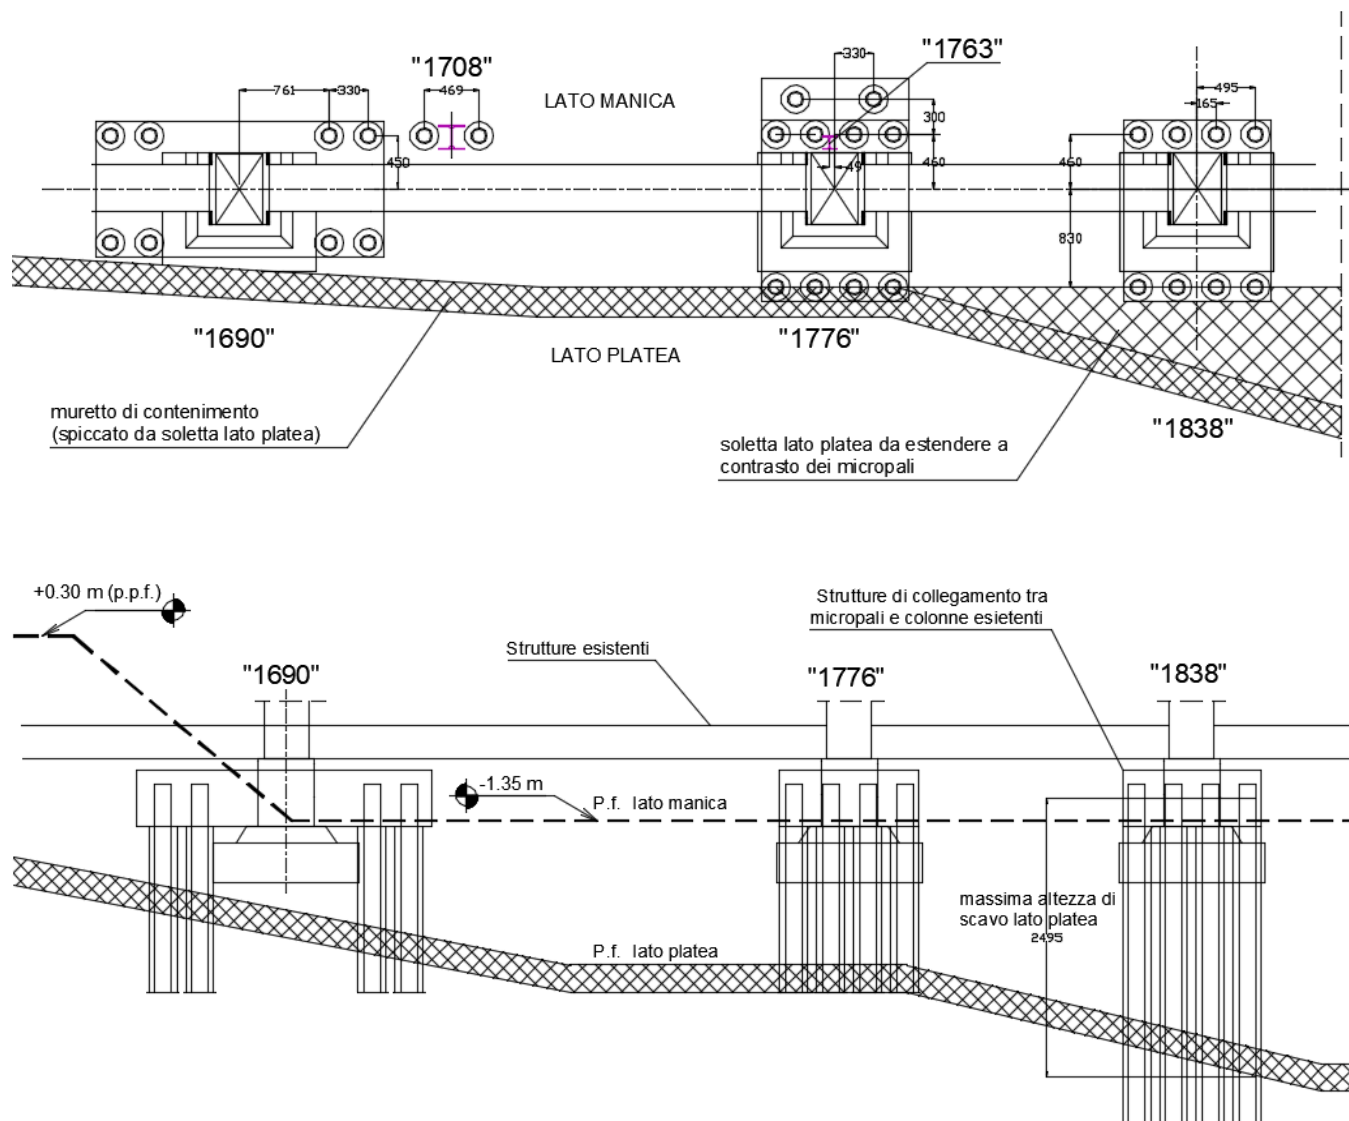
Disposizione planimetrica dei micropali e sezione longitudinale
